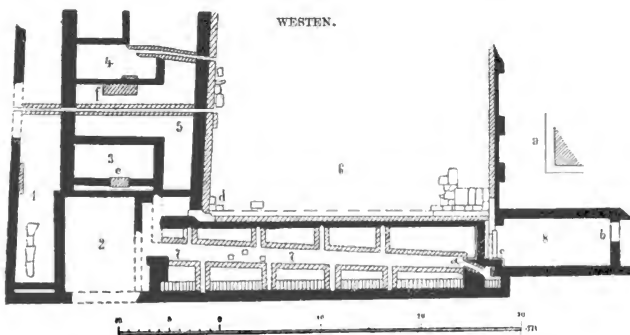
GRUNDRISS DER PALAESTRA.
